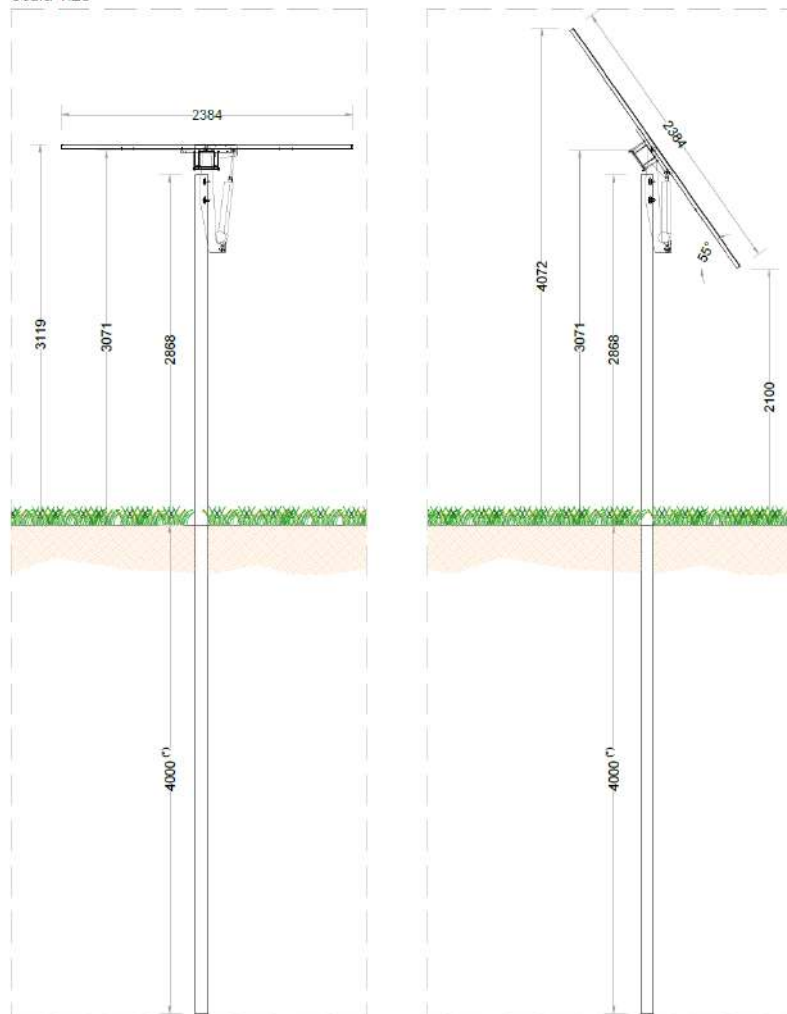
Pianta e prospetti struttura Tracker configurazione 1x14.
